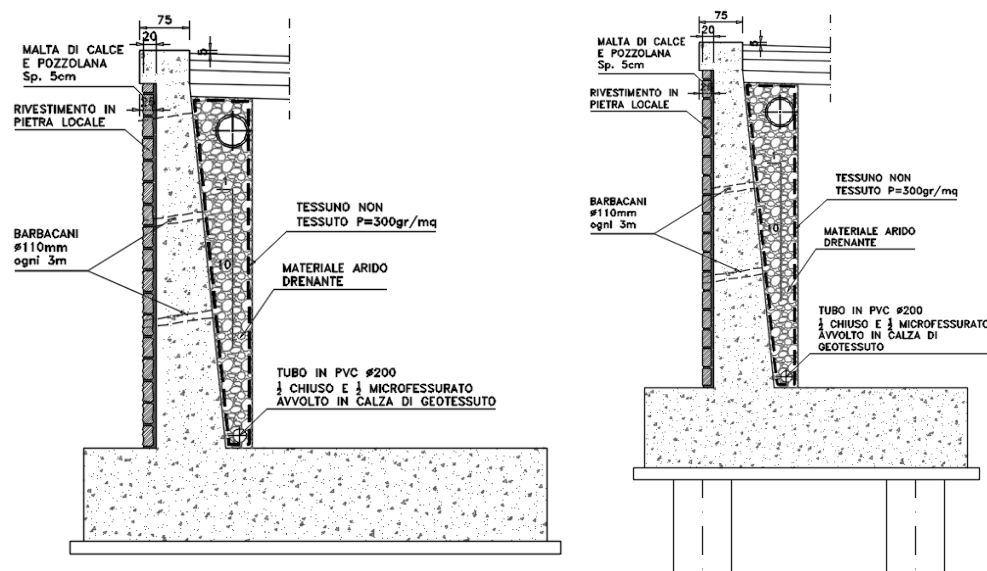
Sezione tipo muro di sostegno su fondazione diretta (a sx) e sezione tipo muro di sostegno su pali (a dx)
